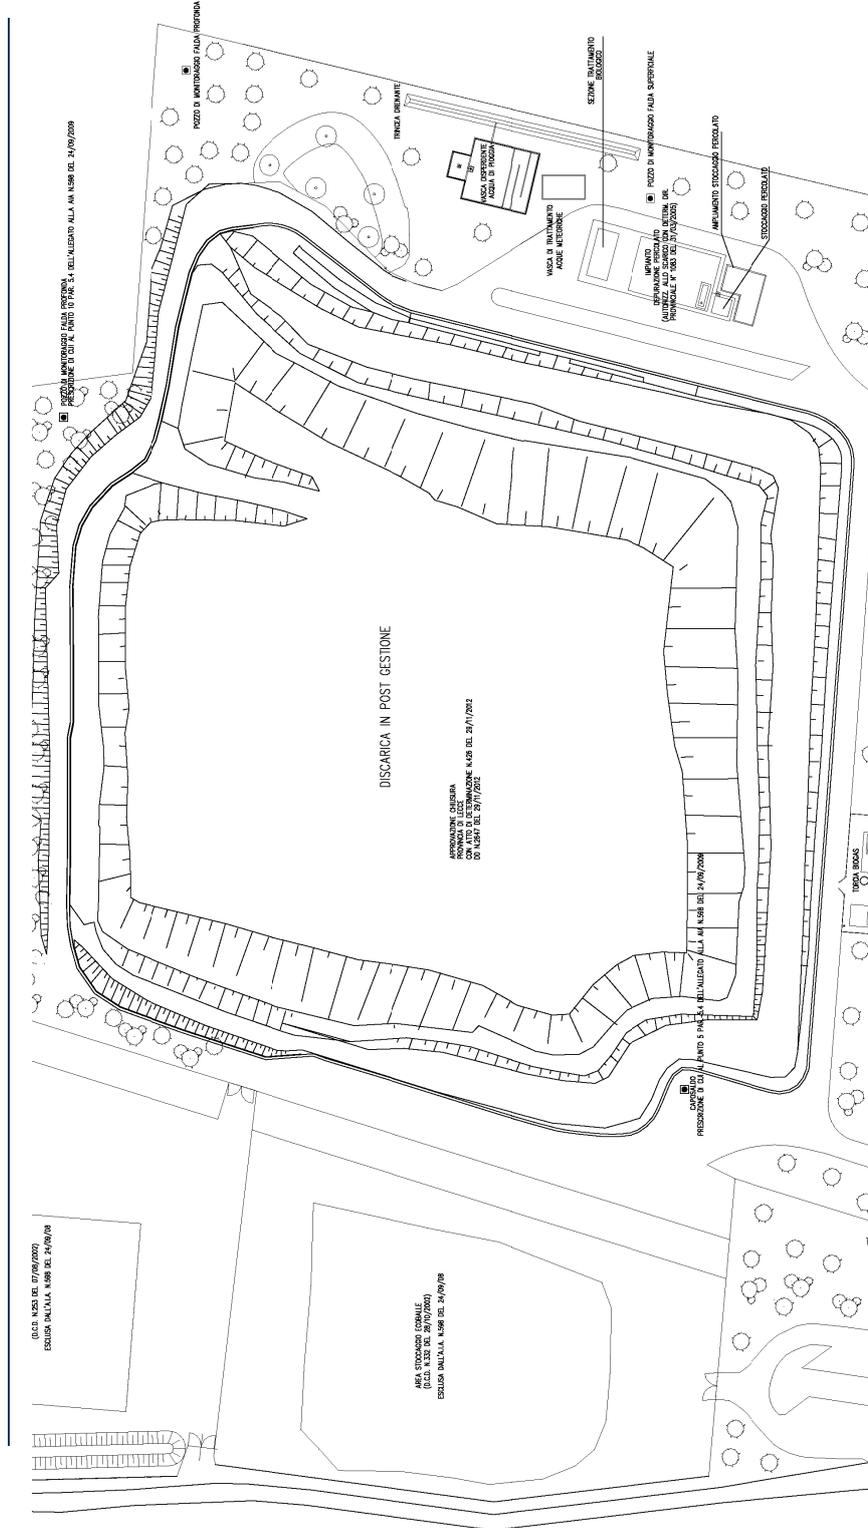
Planimetria generale impianto - stato di fatto - Dettaglio Discarica di servizio
